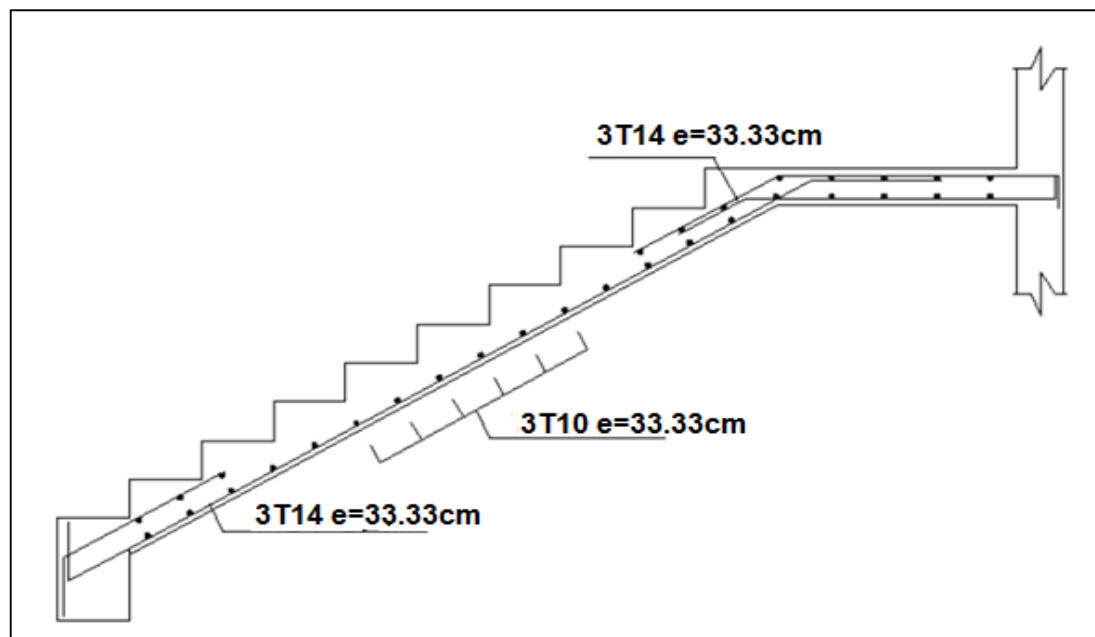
Schéma de ferrailage de l'escalier.
